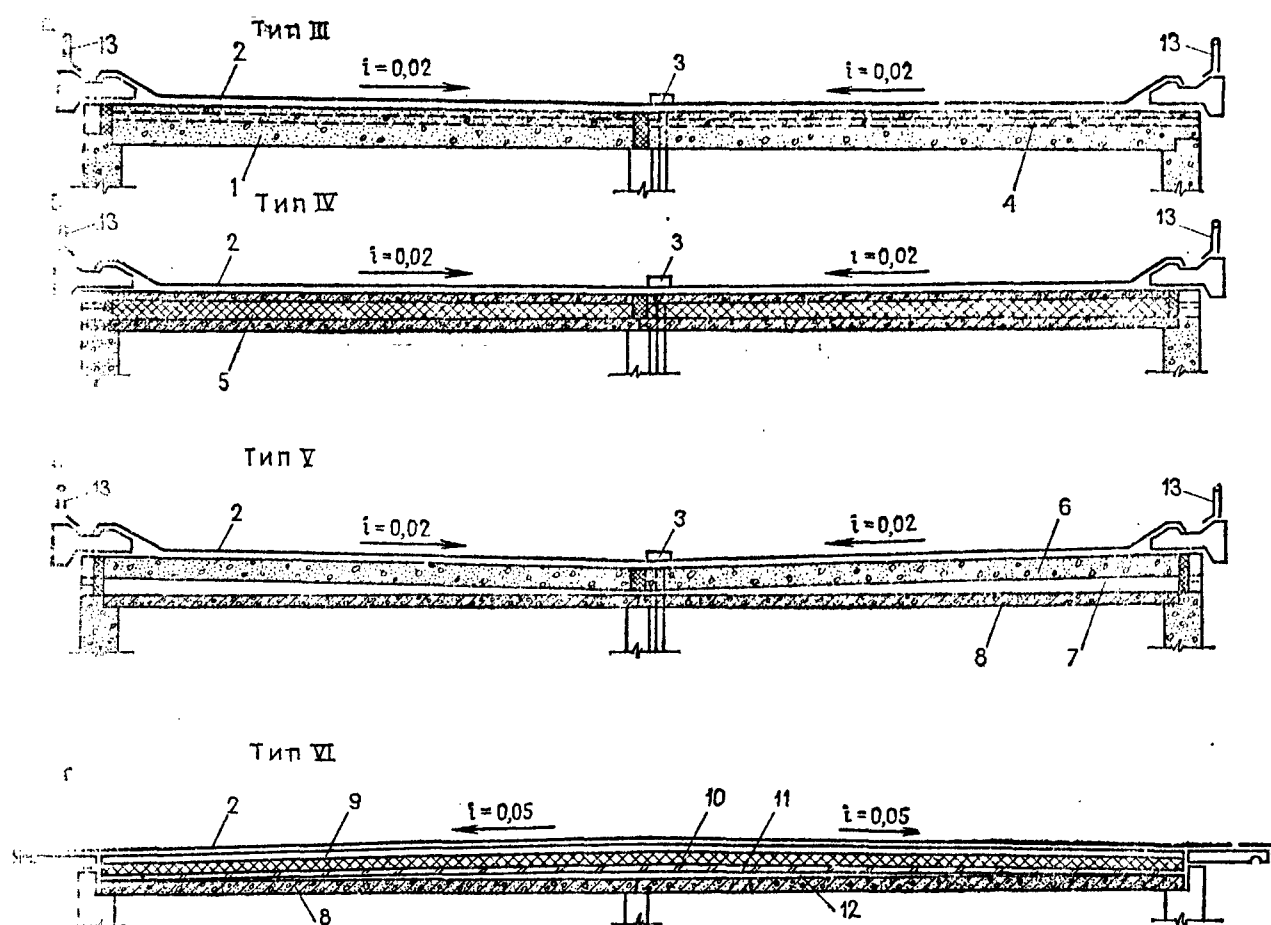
Принципиальные схемы бесчердачных сборных железобетонных совмещенных покрытий (крыш)
